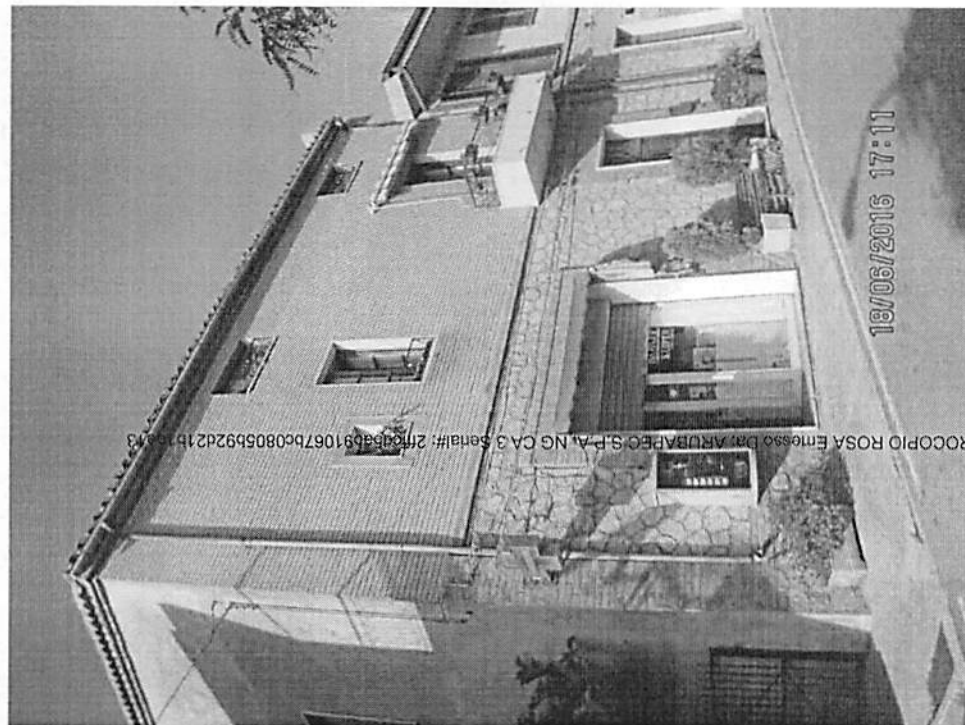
piano terra sub 12 – piano primo e sottotetto sub 13
